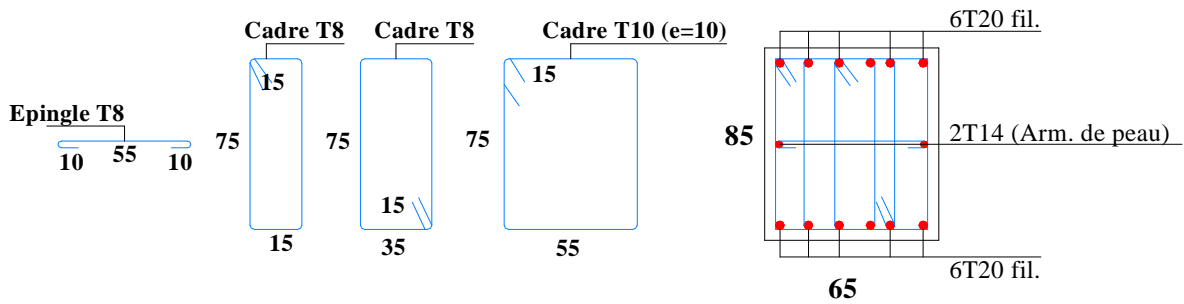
détails de ferrailage d'un appui de nervure.
